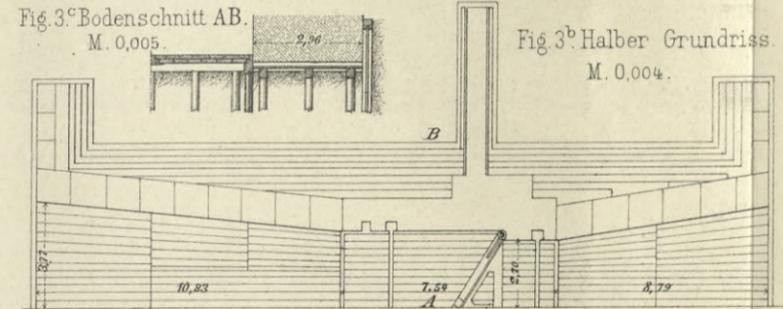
^b Halber Grundriss. M. 0,004.
